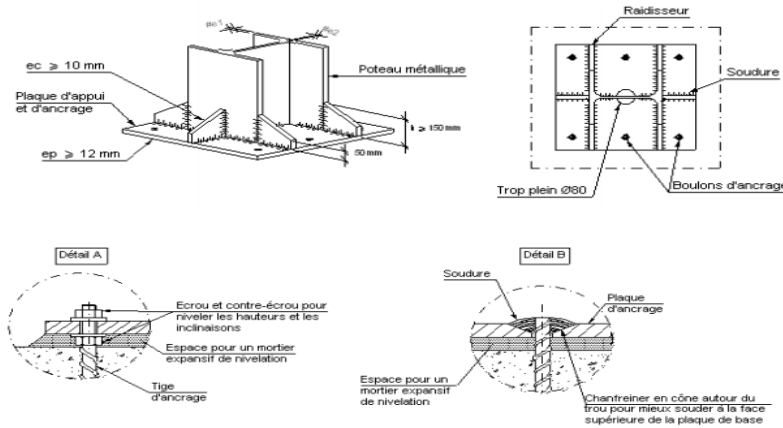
Détails technique de l'encastrement d'un poteau métallique
